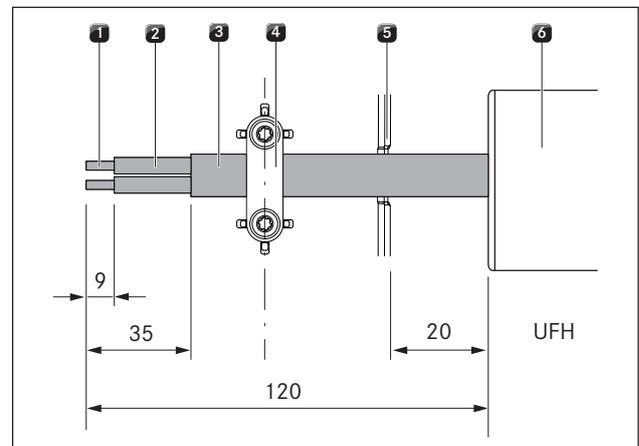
Longitudes de desaislamiento y posición de montaje del cable de conexión
